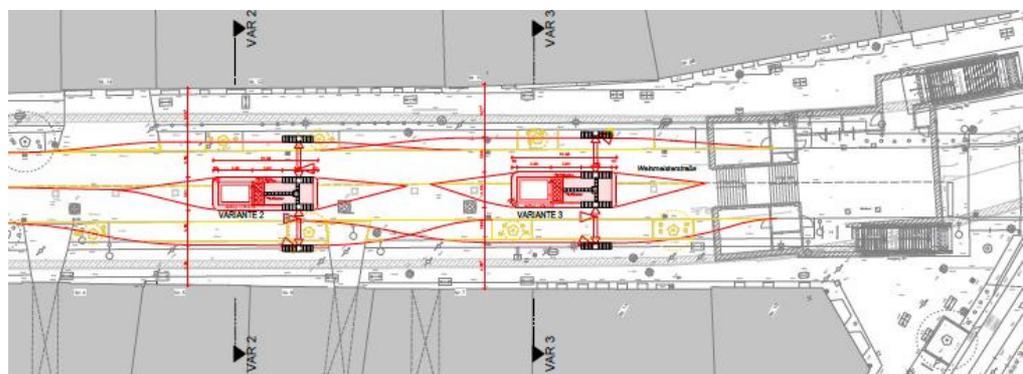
Übersicht Standortvarianten, Variante II und III, Ausschnitt Plan W_PG001
